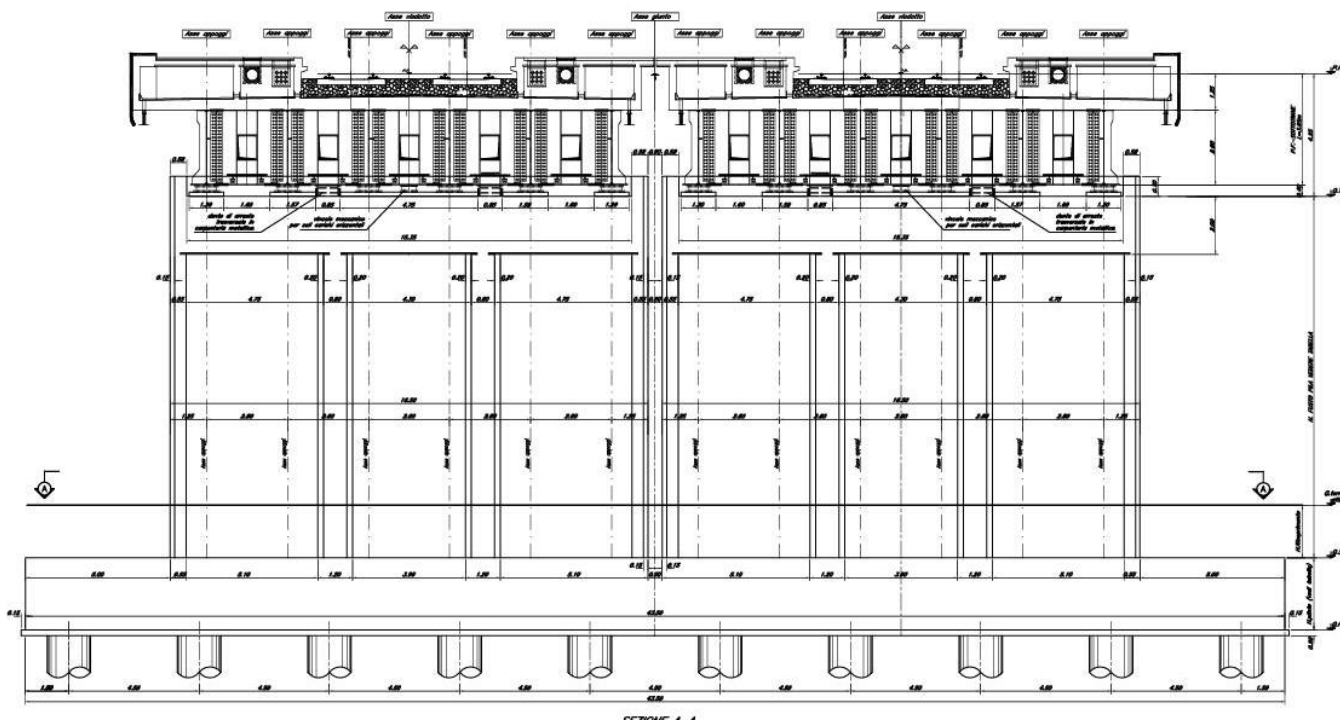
Prospetto Pila P01 – P06 – P07 -sezione trasversale
